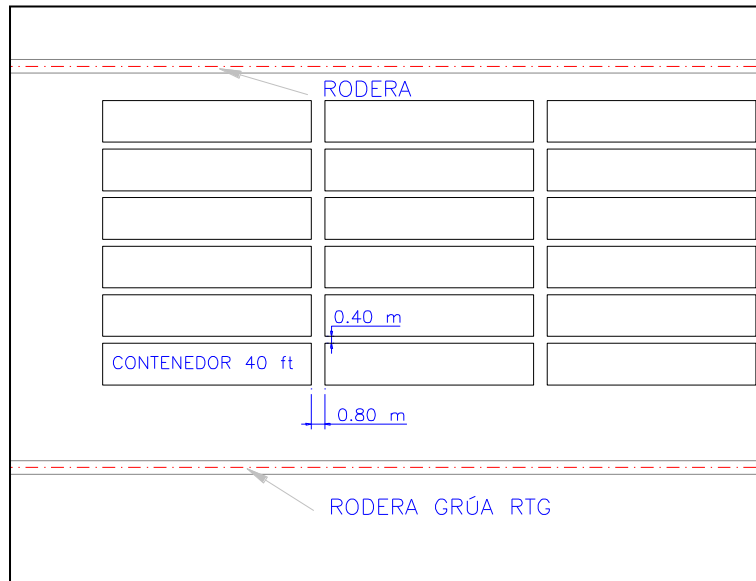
Vista en planta del apilamiento de contenedores, separación entre estibas.
